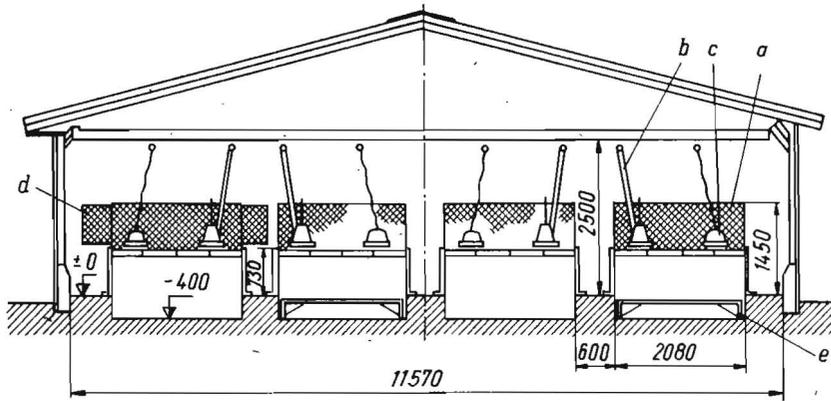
Schnitt durch eine Stallhülle mit dem Maschinensystem R 17 (Prinzipdarstellung);
